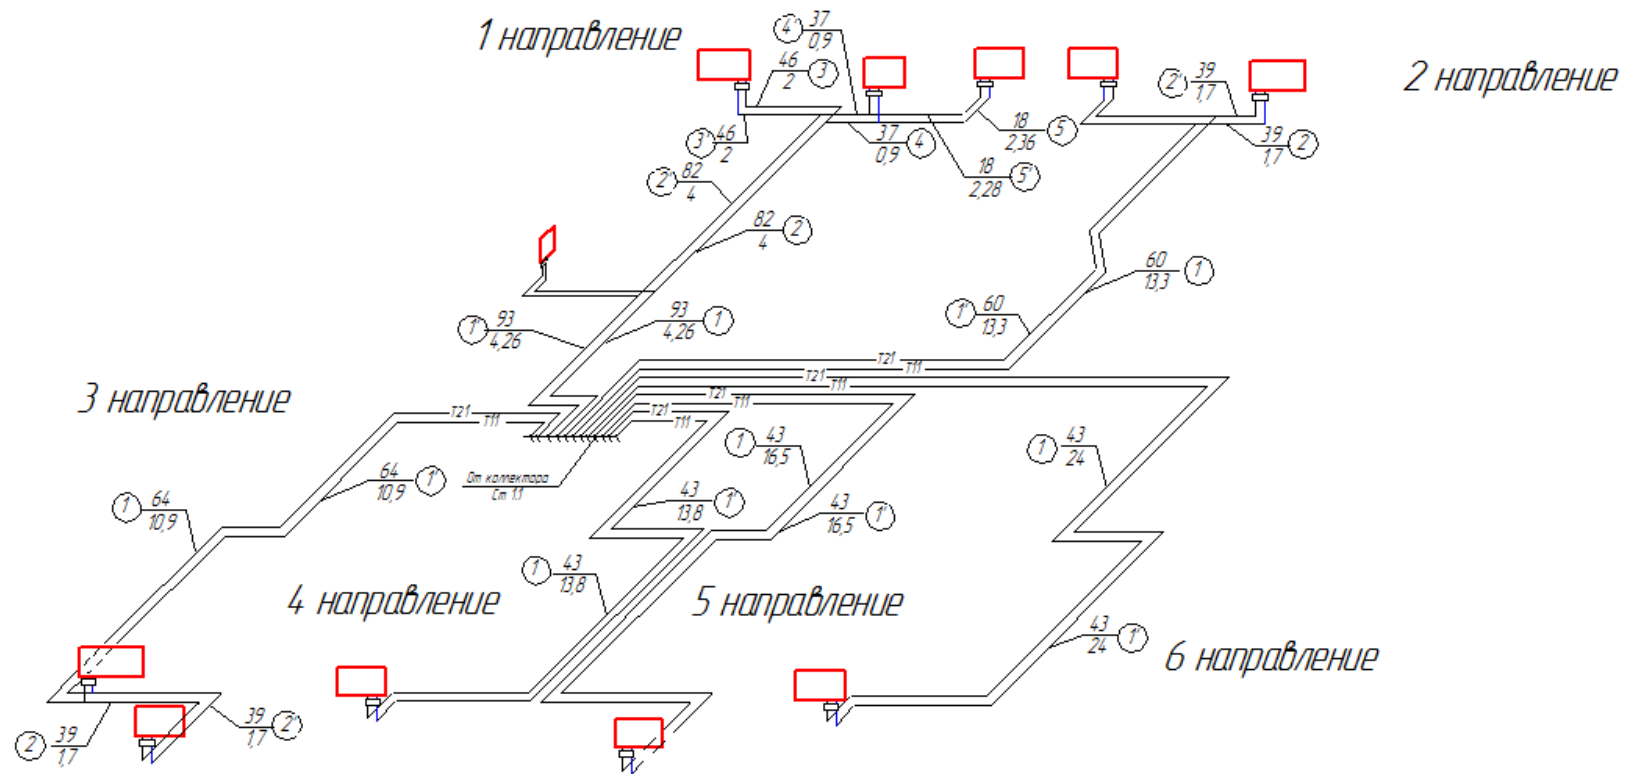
Расчетная схема поквартирной разводки 1-го этажа (БС-1)
